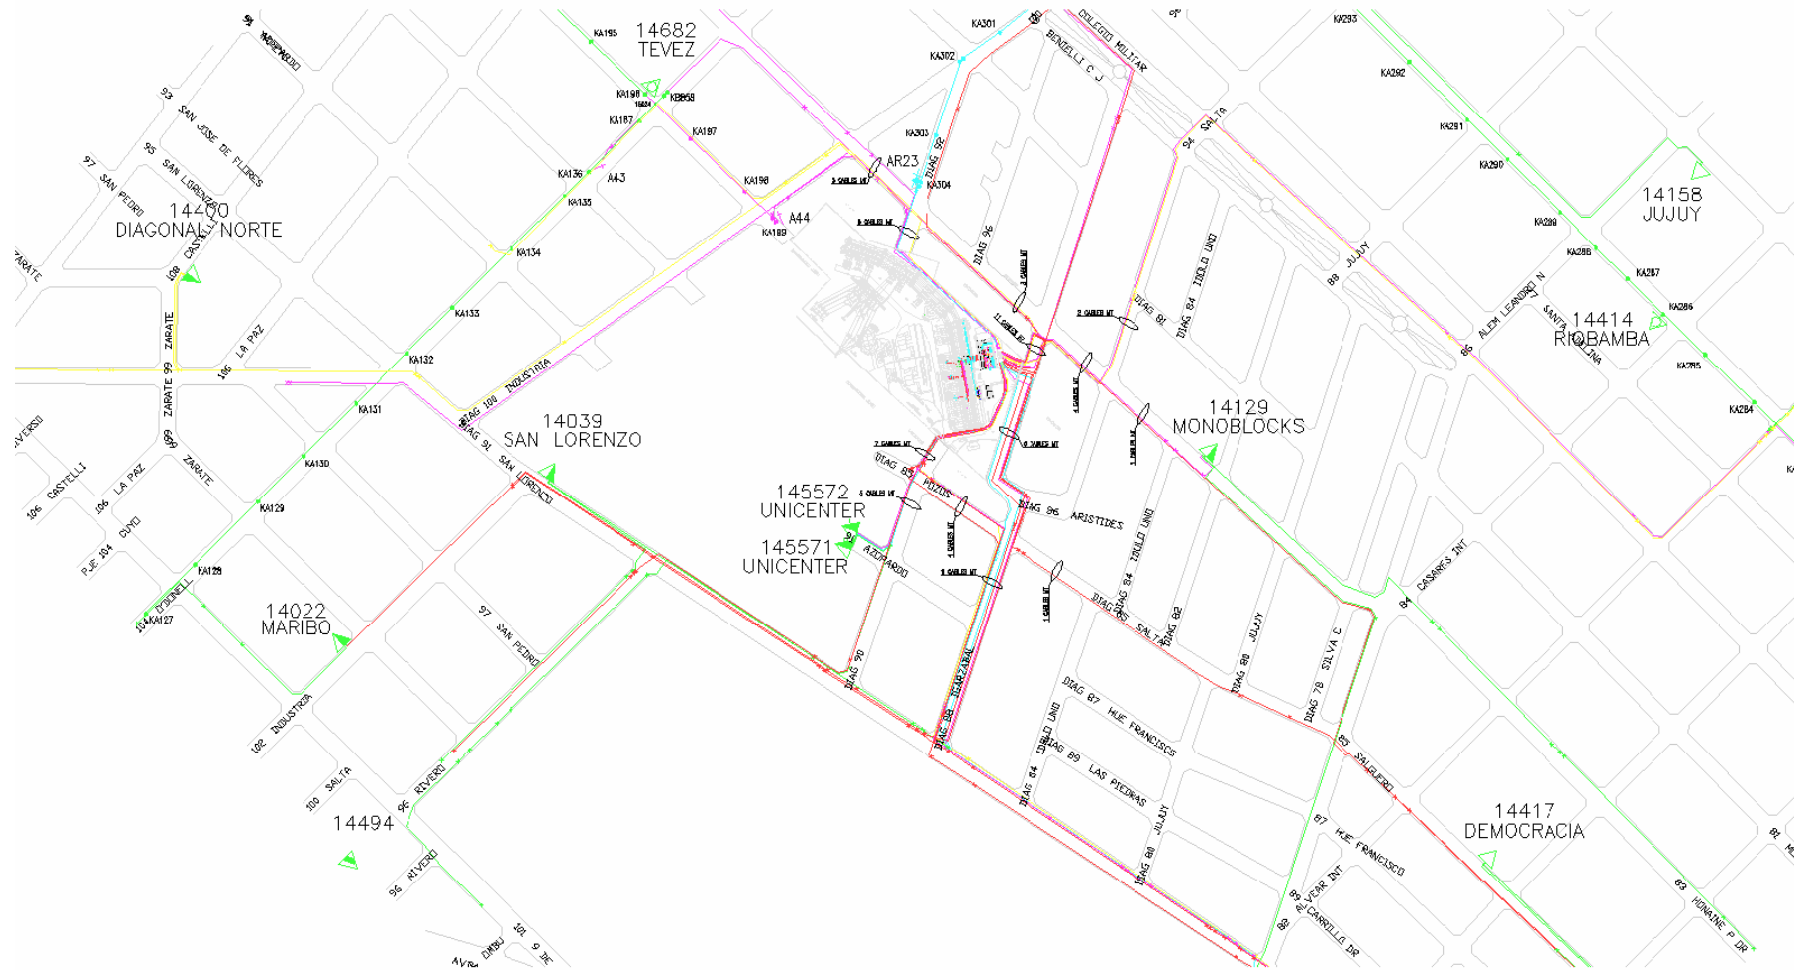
Equipos de Media tensión. Planta. Tendido de cables de 13,2 kV.
